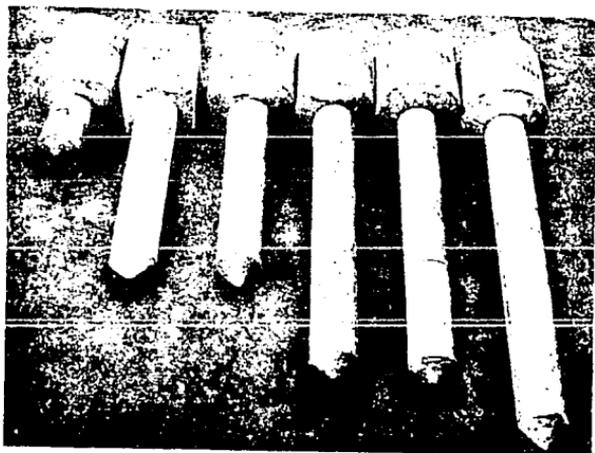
PILOTES MEGA CON PUNTA "T"
